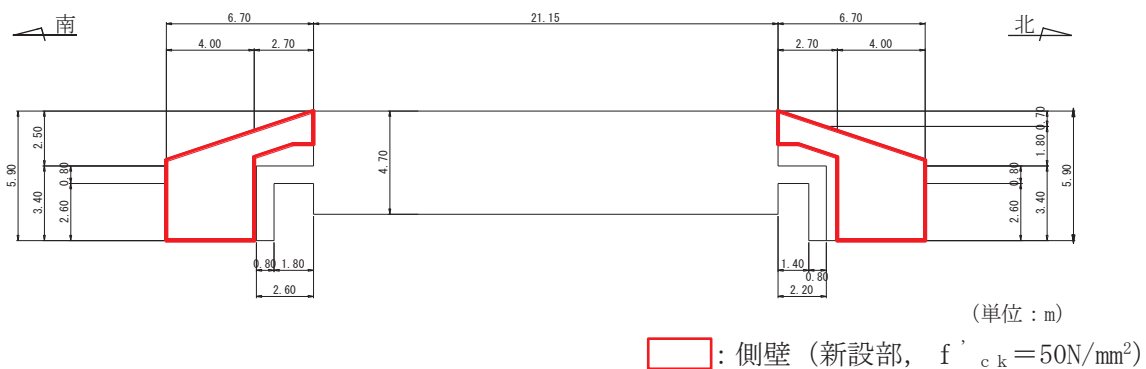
原子炉機器冷却海水配管ダクト (鉛直部) 水平断面図 (断面⑥)
